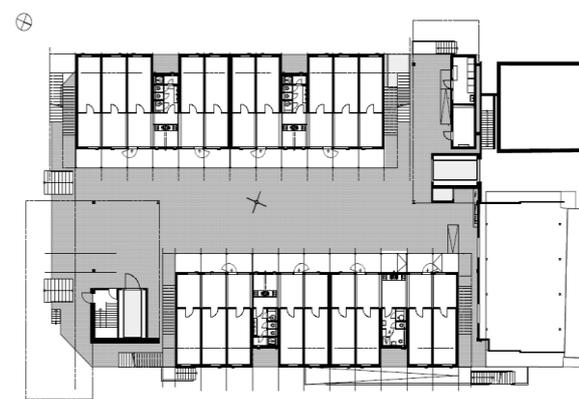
Grundriss Wohncontainer [von: Stadt Zürich]<sup>133</sup>
